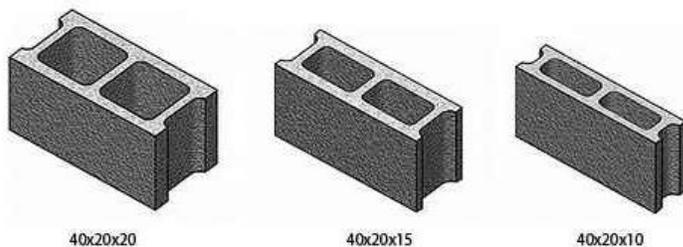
Bloques de concreto. Fuente: *Bloqueras.org- dimensiones de bloques de concreto
